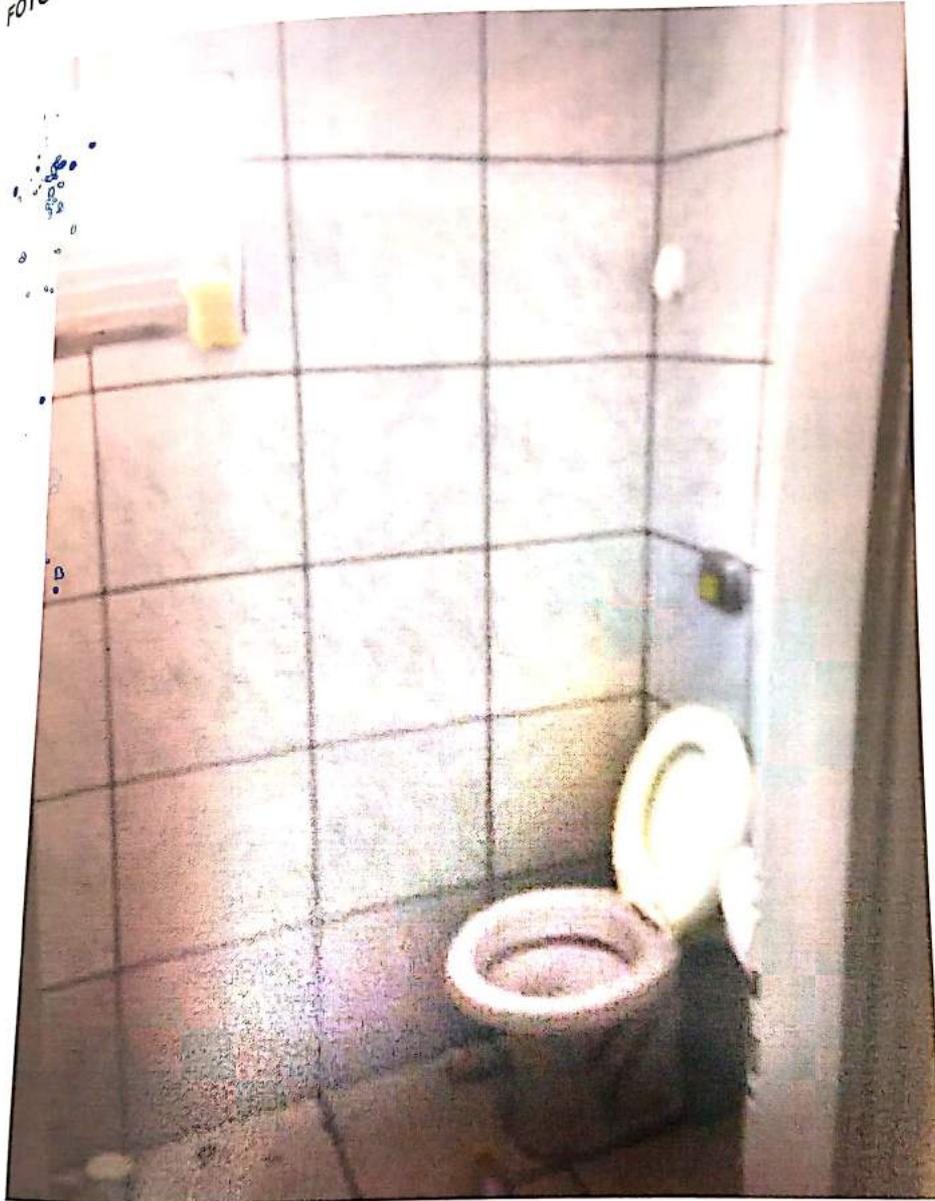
DORMITÓRIO TIPO APARTAMENTO
